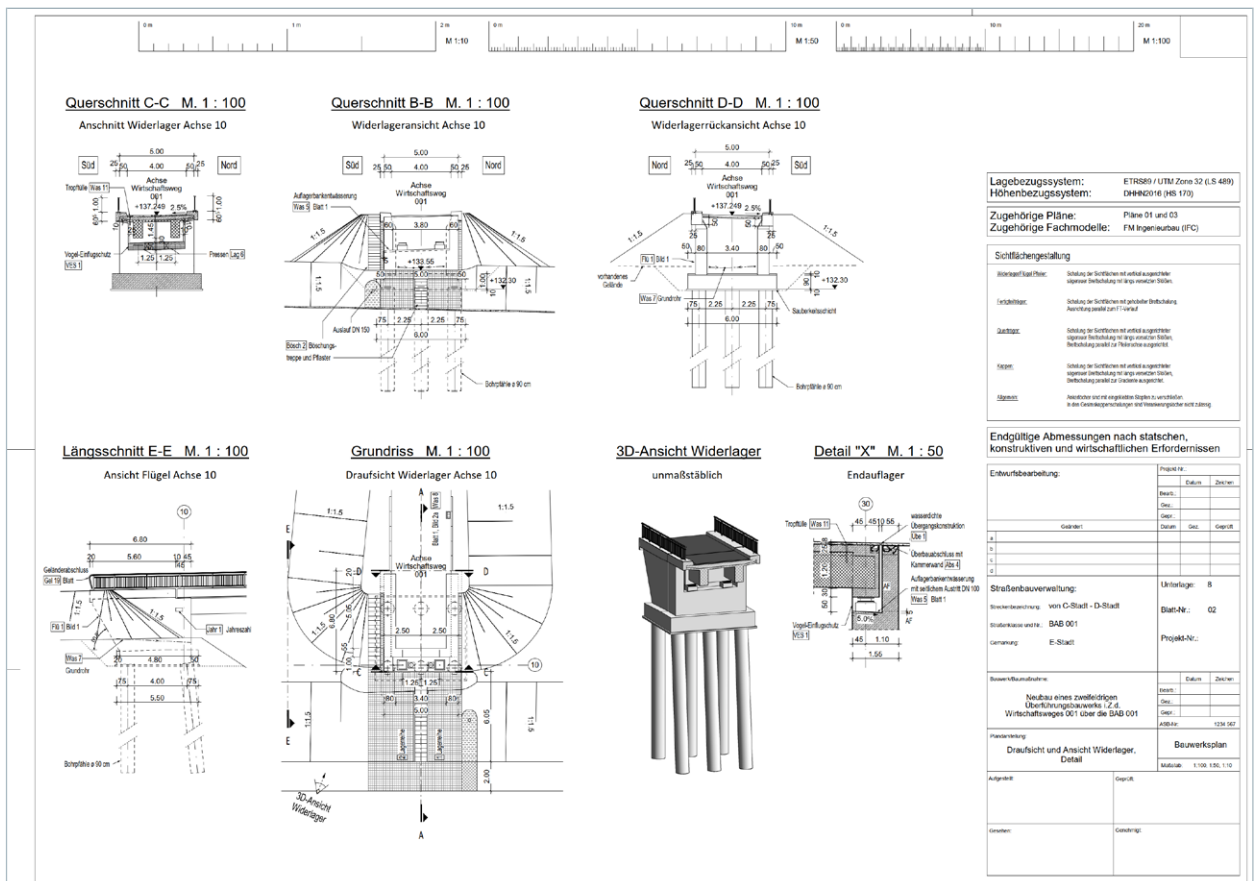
Abgeleiteter Plan mit Darstellung der Widerlager des Musterbeispiels 6-2-1 (© Schübler-Plan)
